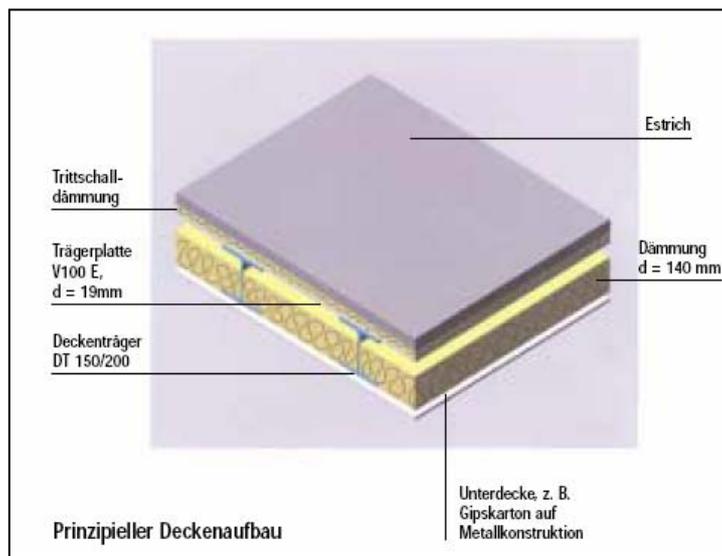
Prinzipieller Deckenaufbau Stahlleichtbauweise; Isometrie, aus [Z3]
